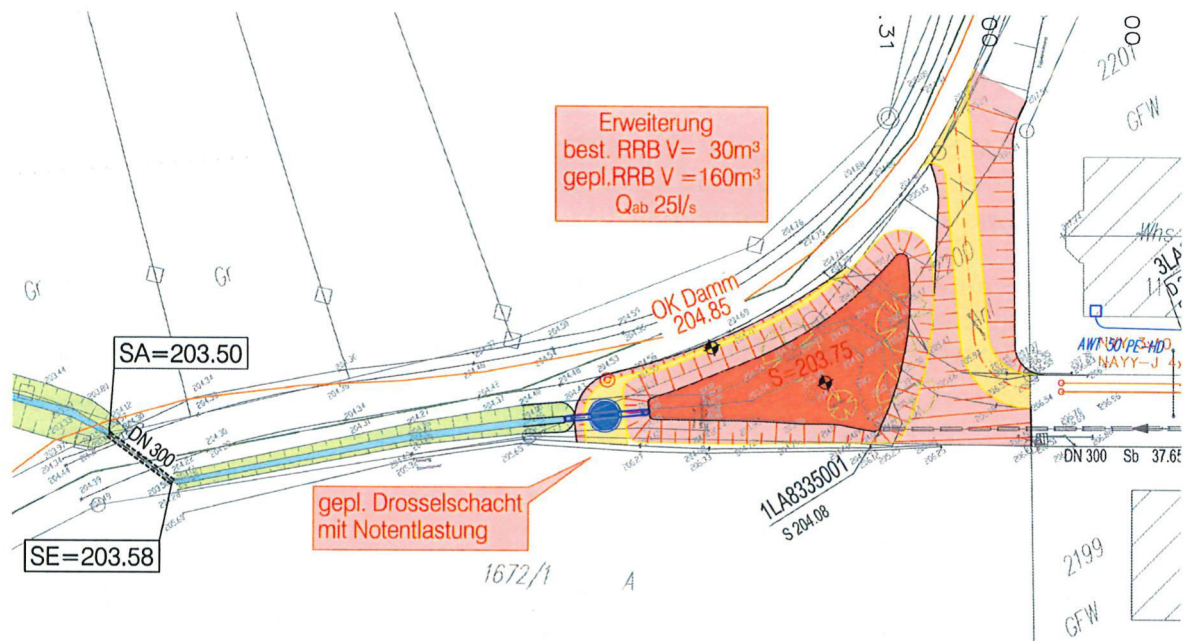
geplante Erweiterung Regenrückhaltebecken „Rötel“
